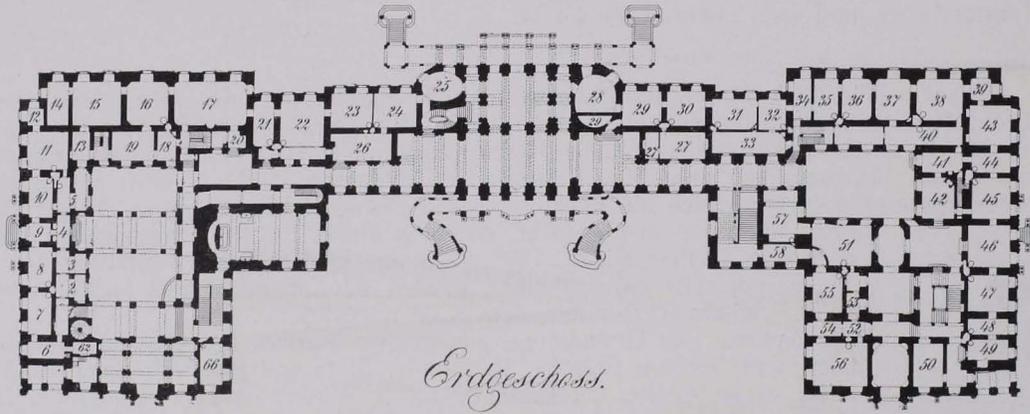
Schönbrunn, Grundriß des Erdgeschosses (S. 118)
